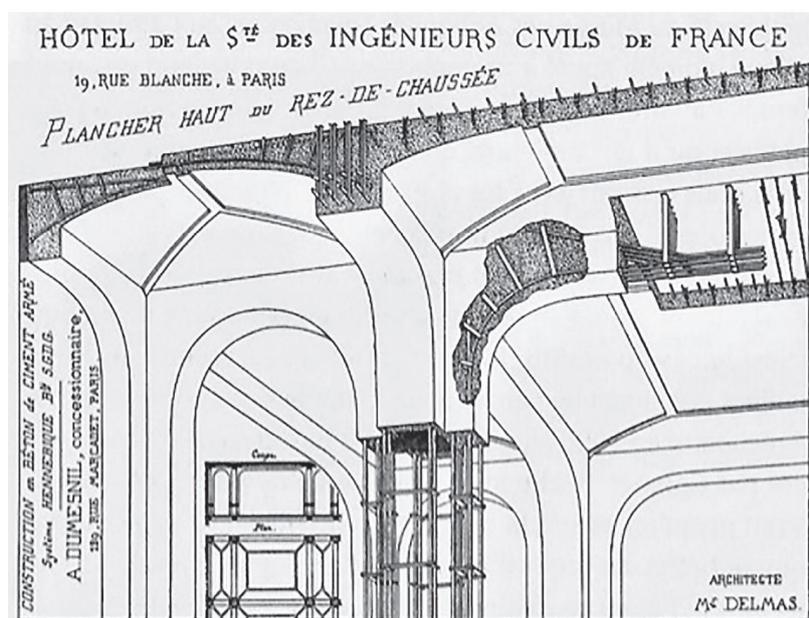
Système Hennebique qui montre la liaison structurale poteau-poutre. Source : Delhumeau, 1999.
